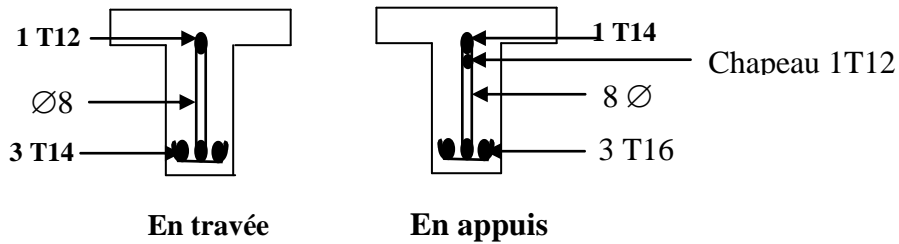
Ferrailage de la poutrelle Terrasse inaccessible
